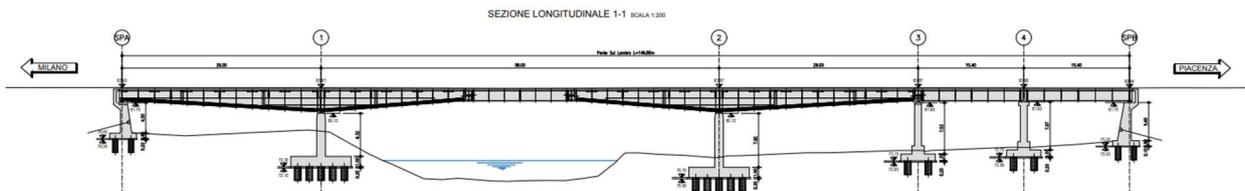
Sezione Longitudinale Viadotto Lambro – configurazione approvata
